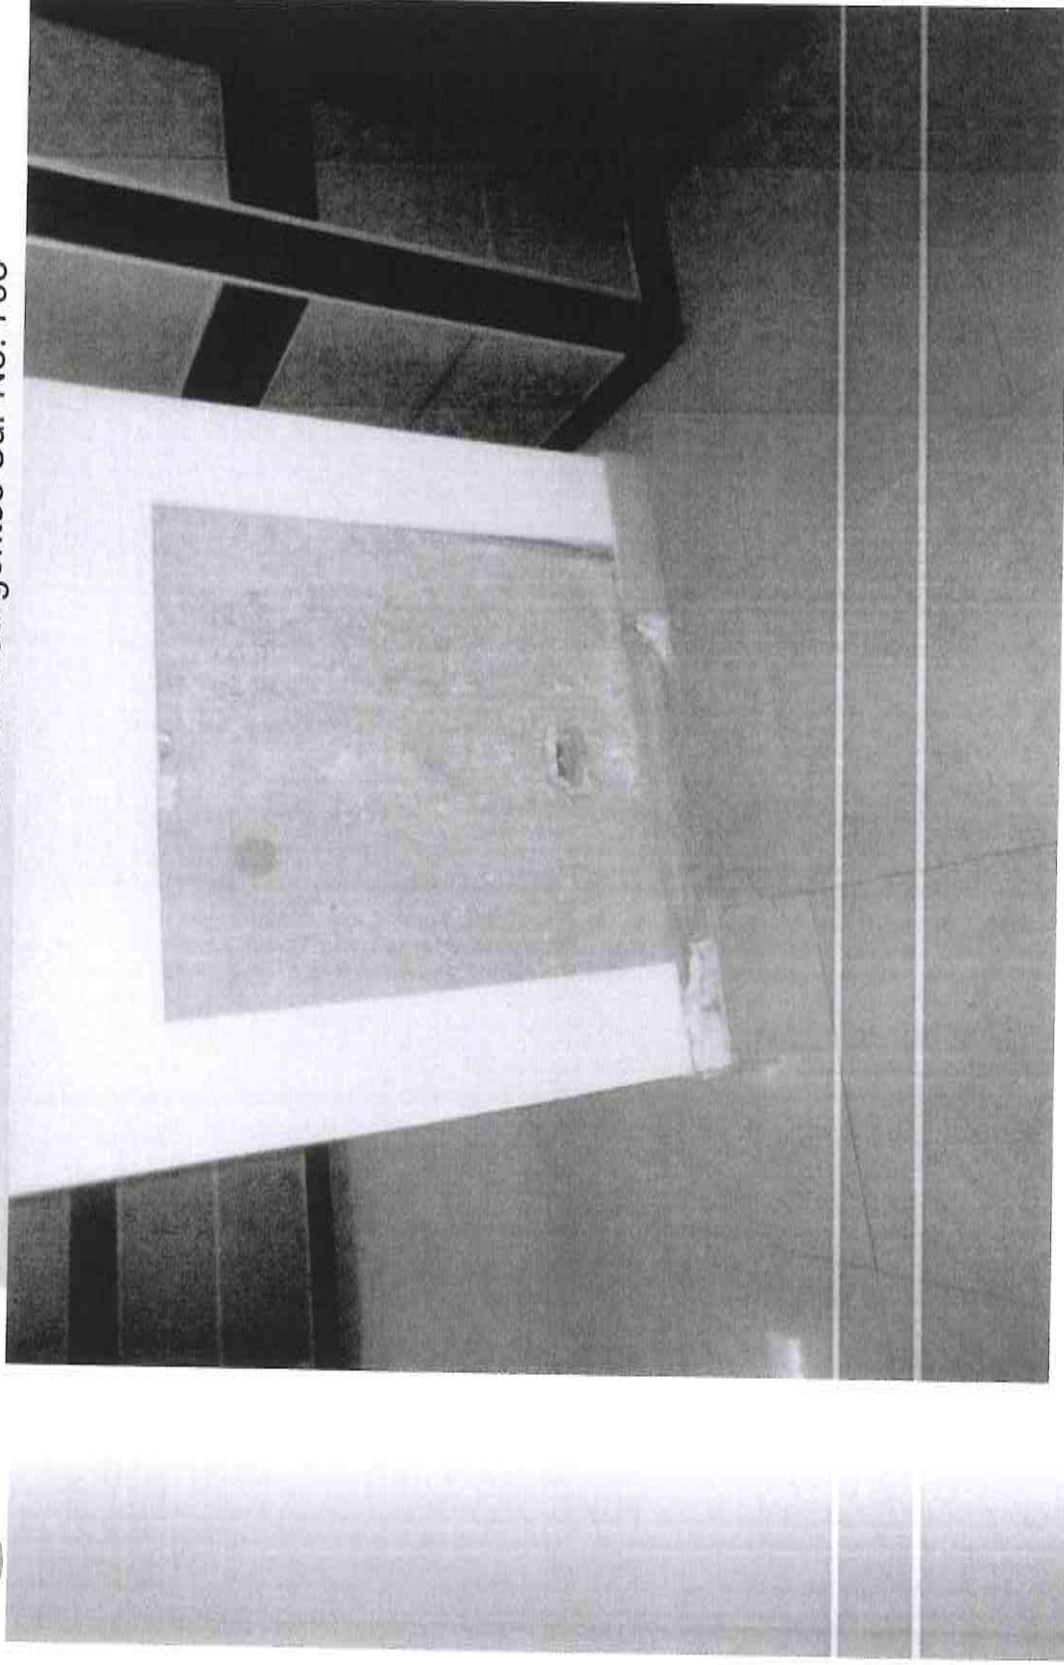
Nivel 7 fisuras en capa de compresión, de losa Nervada.
